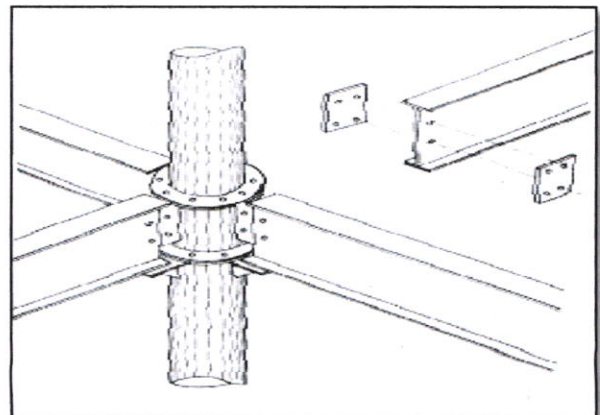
jonction poteau poutre ; source : auteurs 2018.
